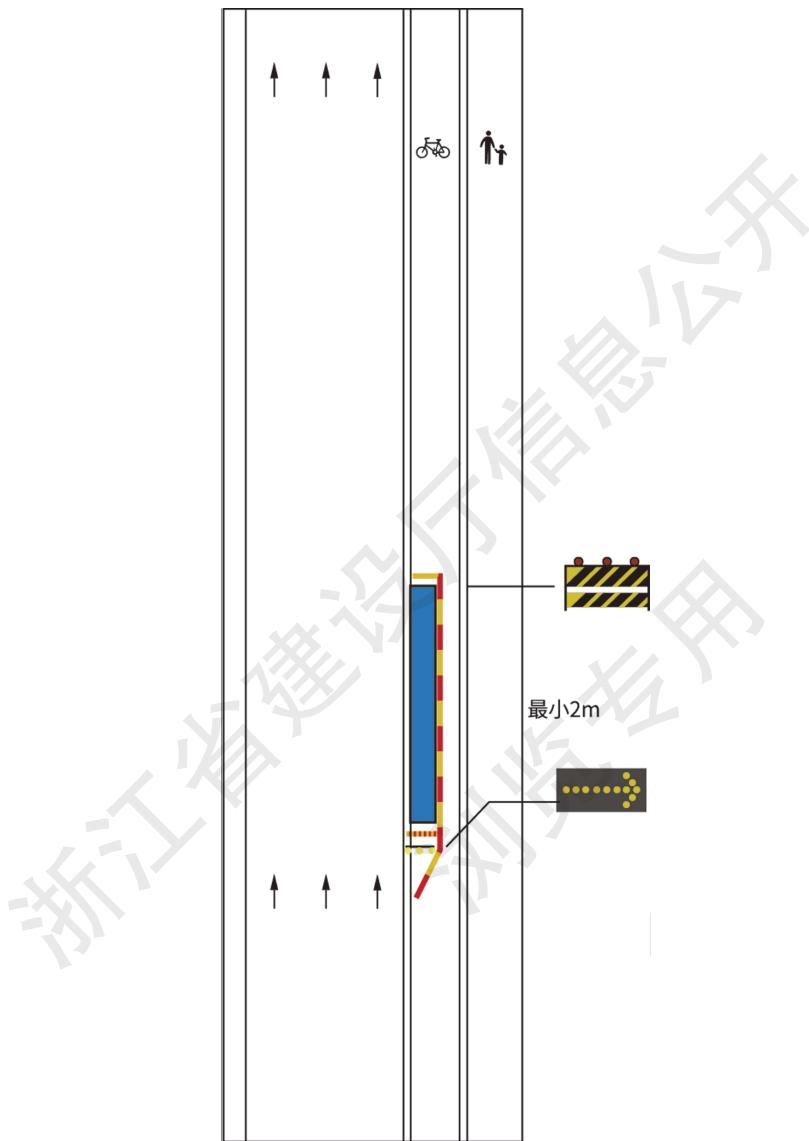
主干道非机动车道养护作业控制区布置示意
